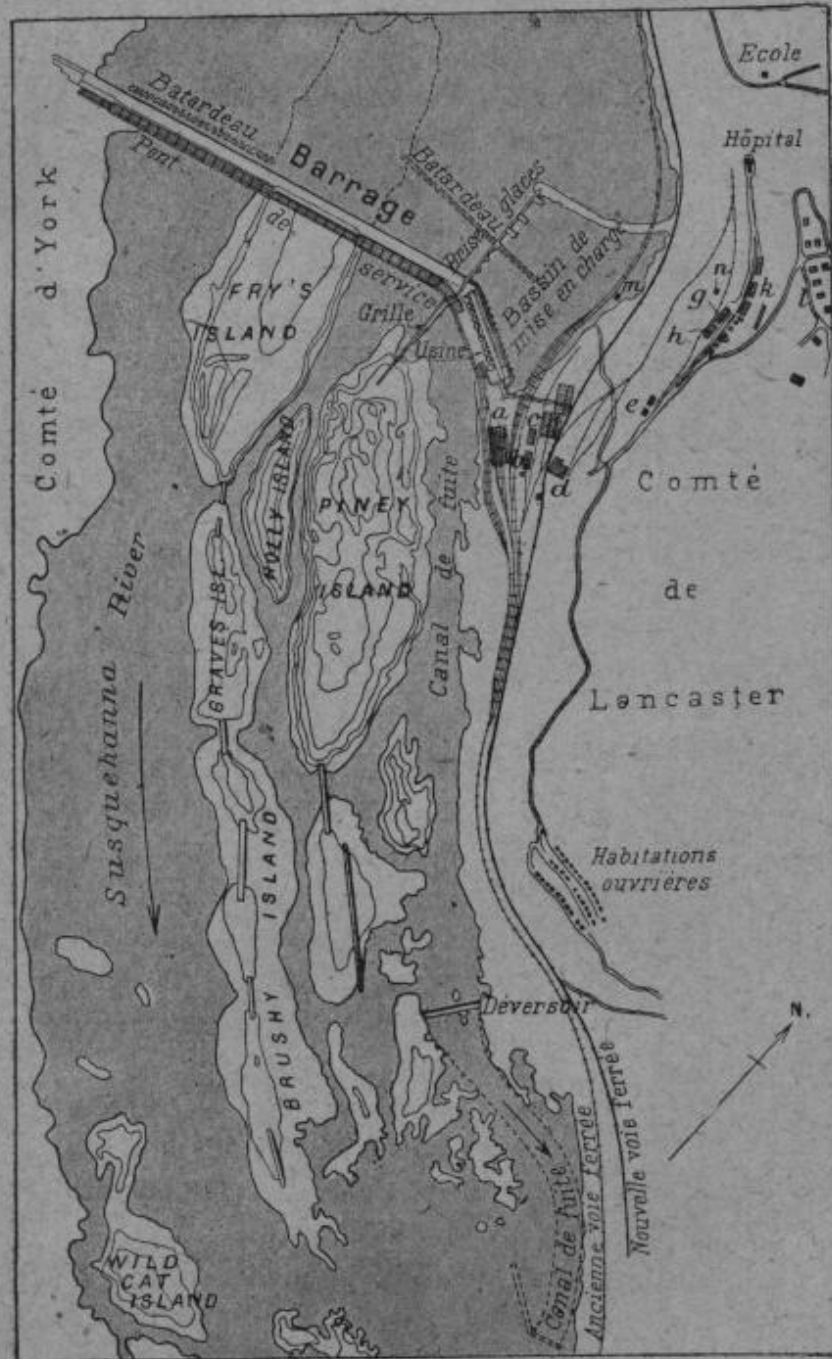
Usine de Mac Call Ferry. Plan des ouvrages hydrauliques.
